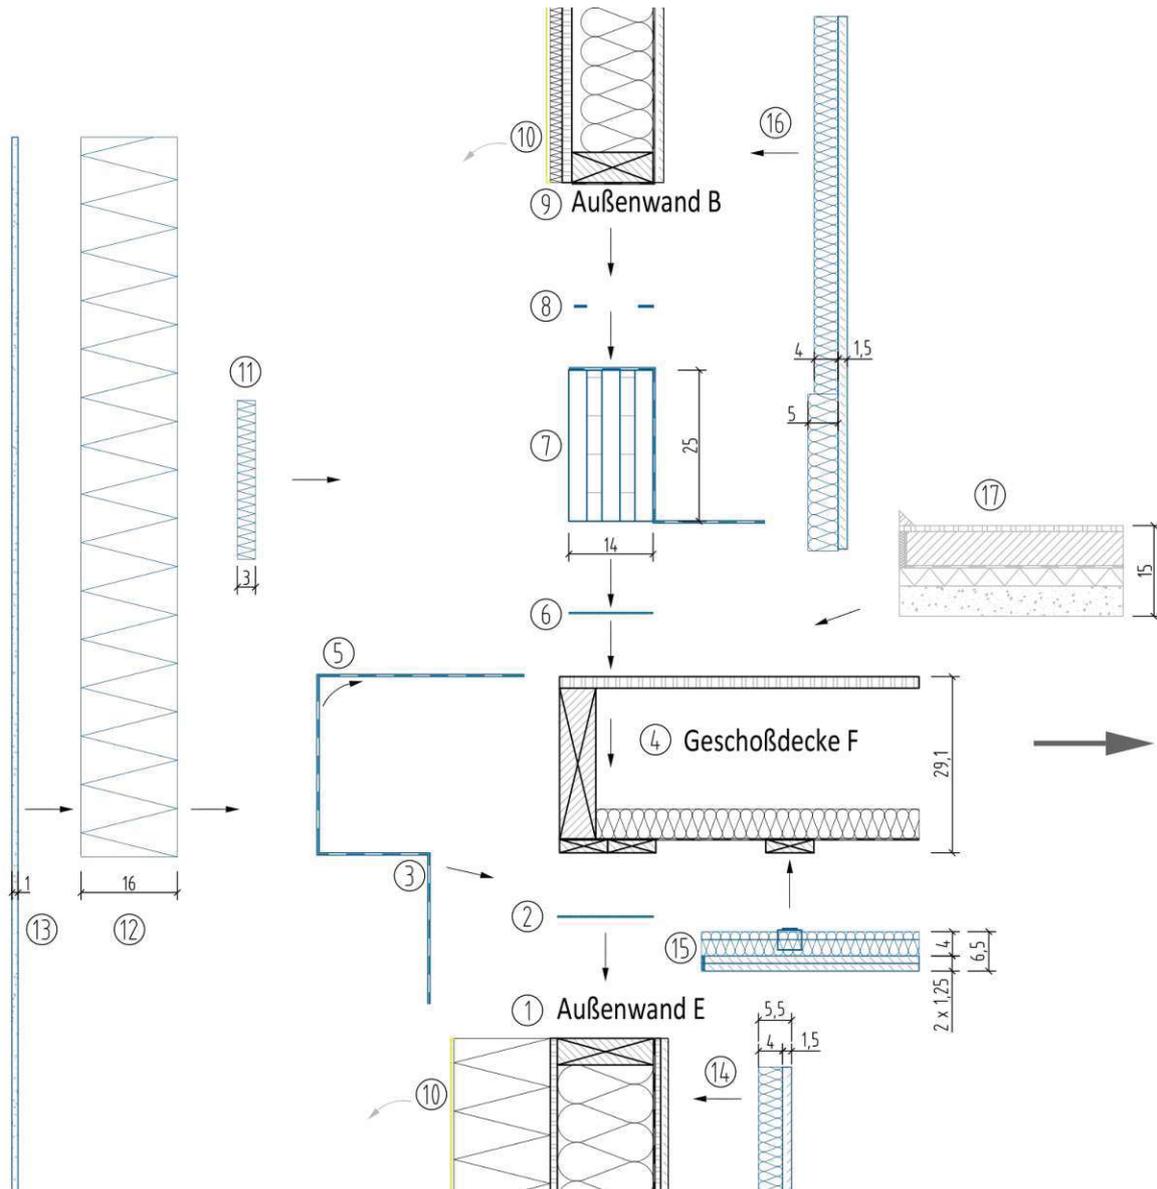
Bauteilfügung Außenwand E – Geschoßdecke F – Außenwand B (Quelle: eigene Darstellung)
